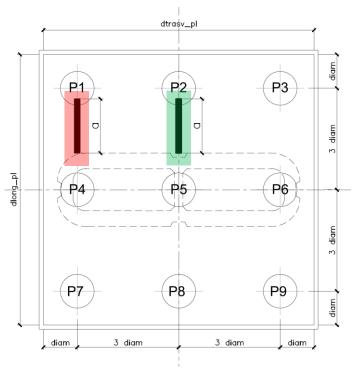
Vista in pianta - Tirante-puntone centrale (verde) e di spigolo (rosso)
